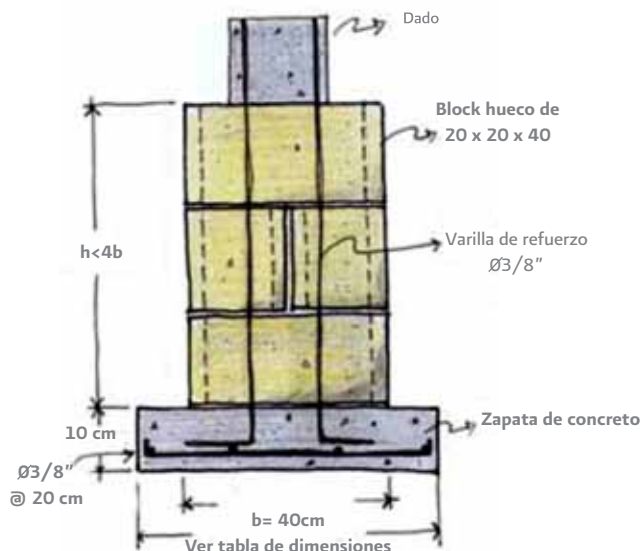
Cimentación con placa de concreto y dado con bloques huecos de concreto.
